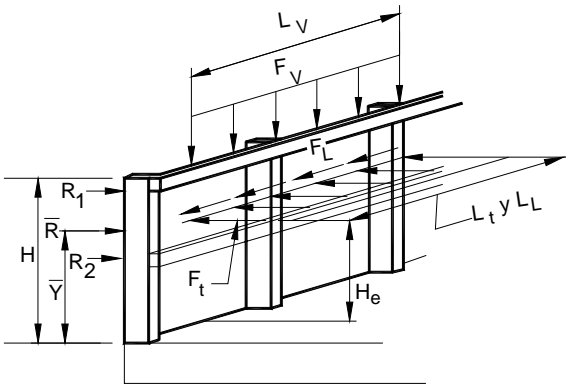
Fuerzas de diseño en una baranda metálica, ubicación en altura y longitud de distribución horizontal
